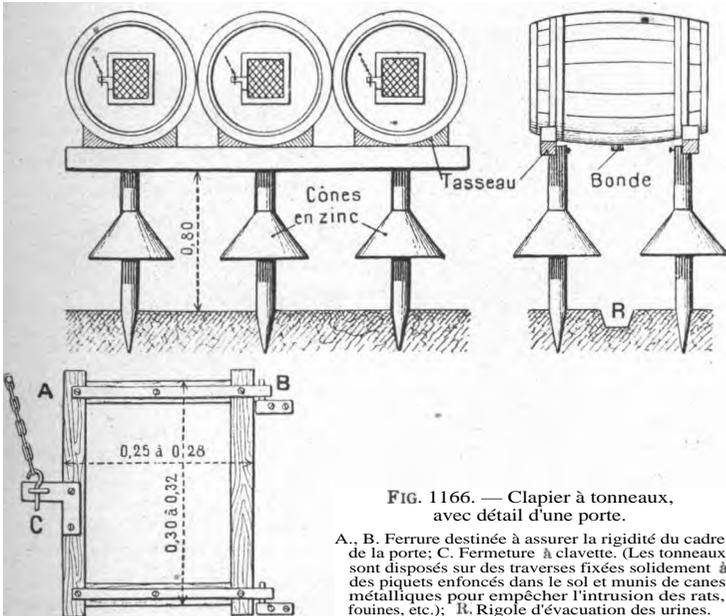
Clapier à tonneaux, avec détail d'une porte.
